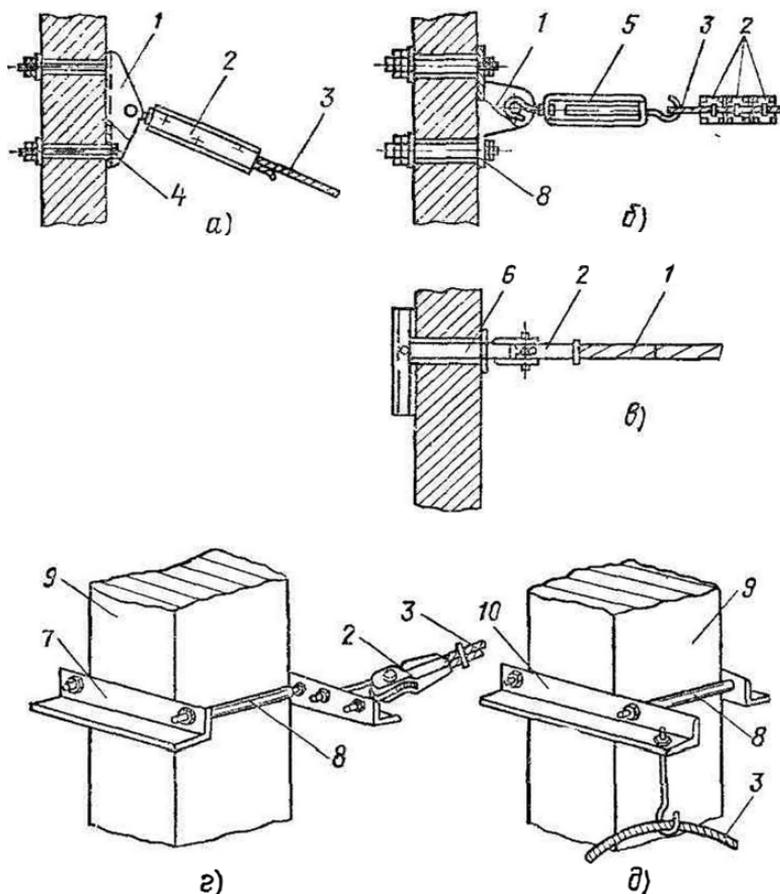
Установка анкеров на стене и обхватов на колонне:
